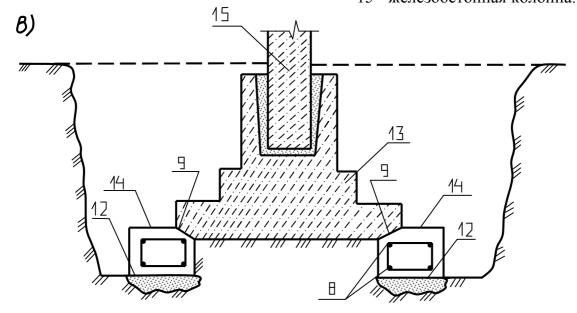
Конструкция усиления бетонных и железобетонных фундаментов
